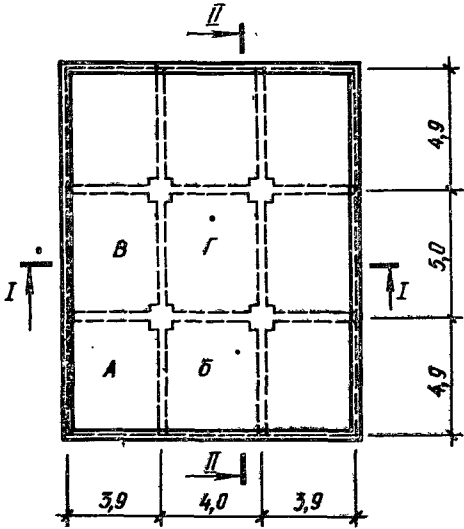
Размеры монолитного железобетонного перекрытия (размеры в м).
